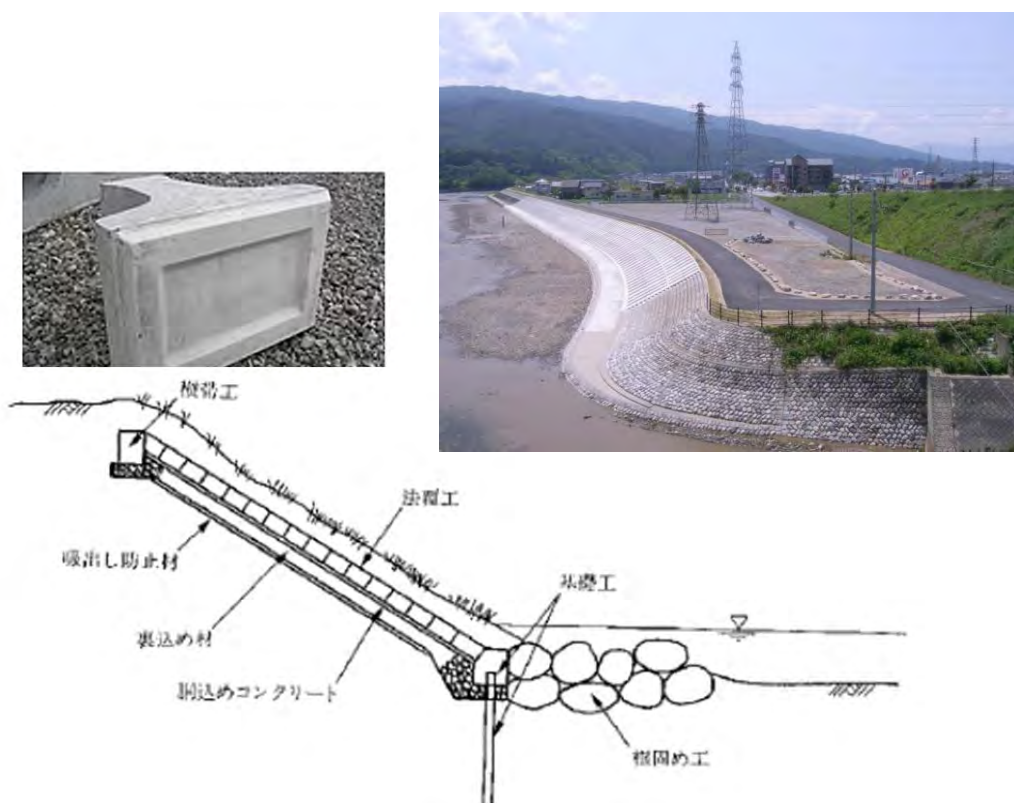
Estructura de protección del banco de la orilla con concreto
